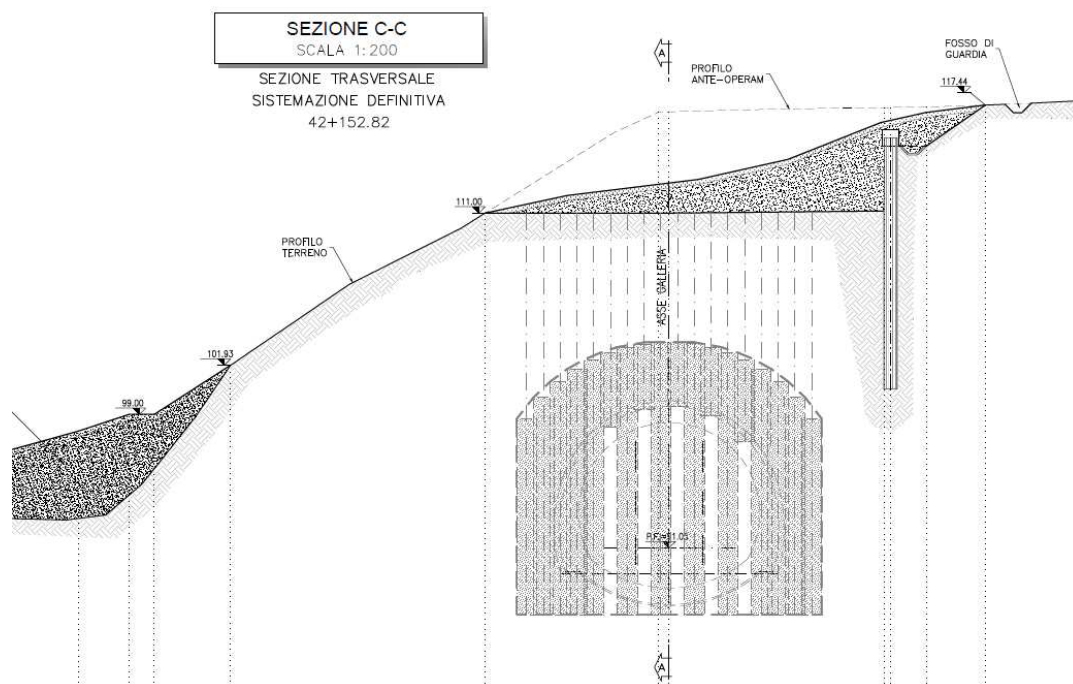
Galleria Ponte. Rimodellazione versante e intervento in jet-grouting dall'alto
